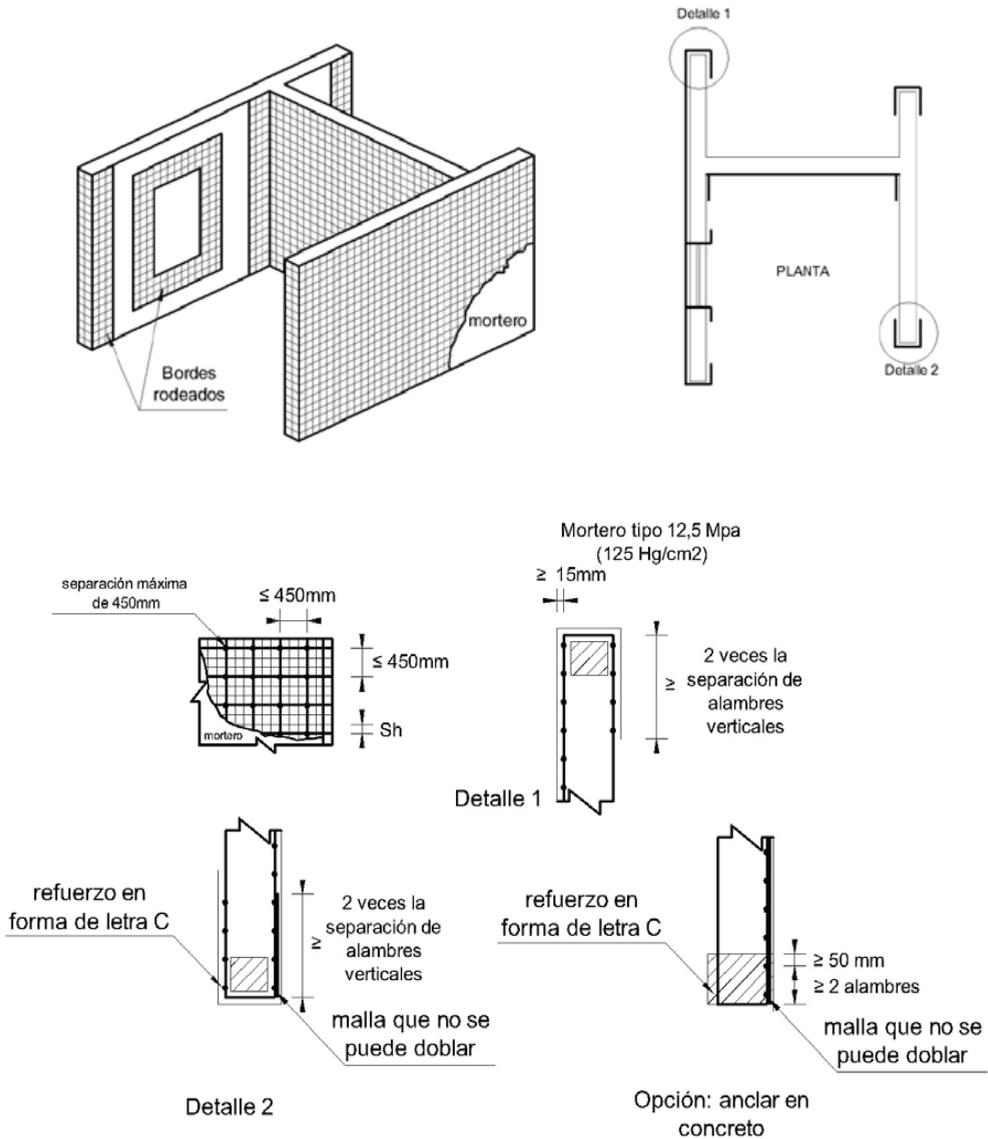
Enchapado de muros con malla electro-soldada, detalles constructivos
